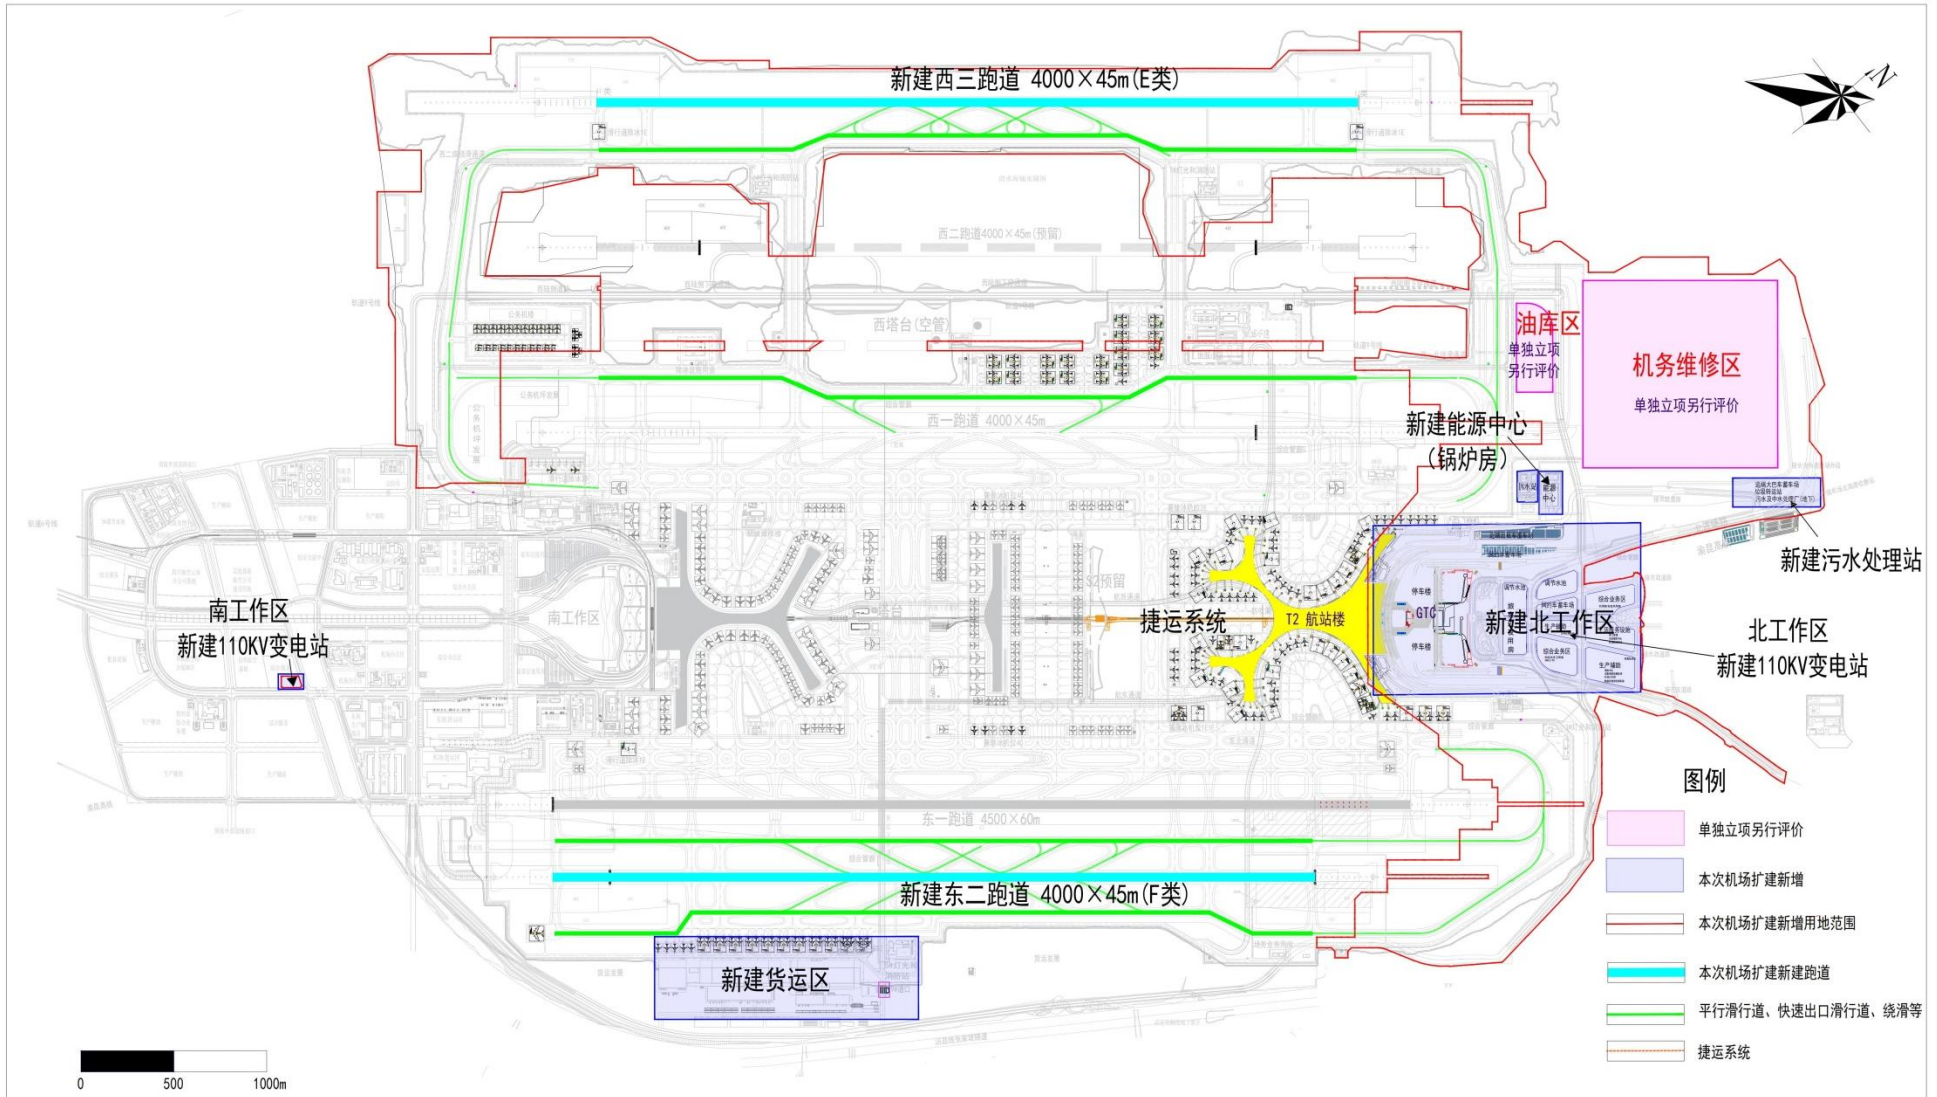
昆明长水国际机场改扩建工程总平面布置图
